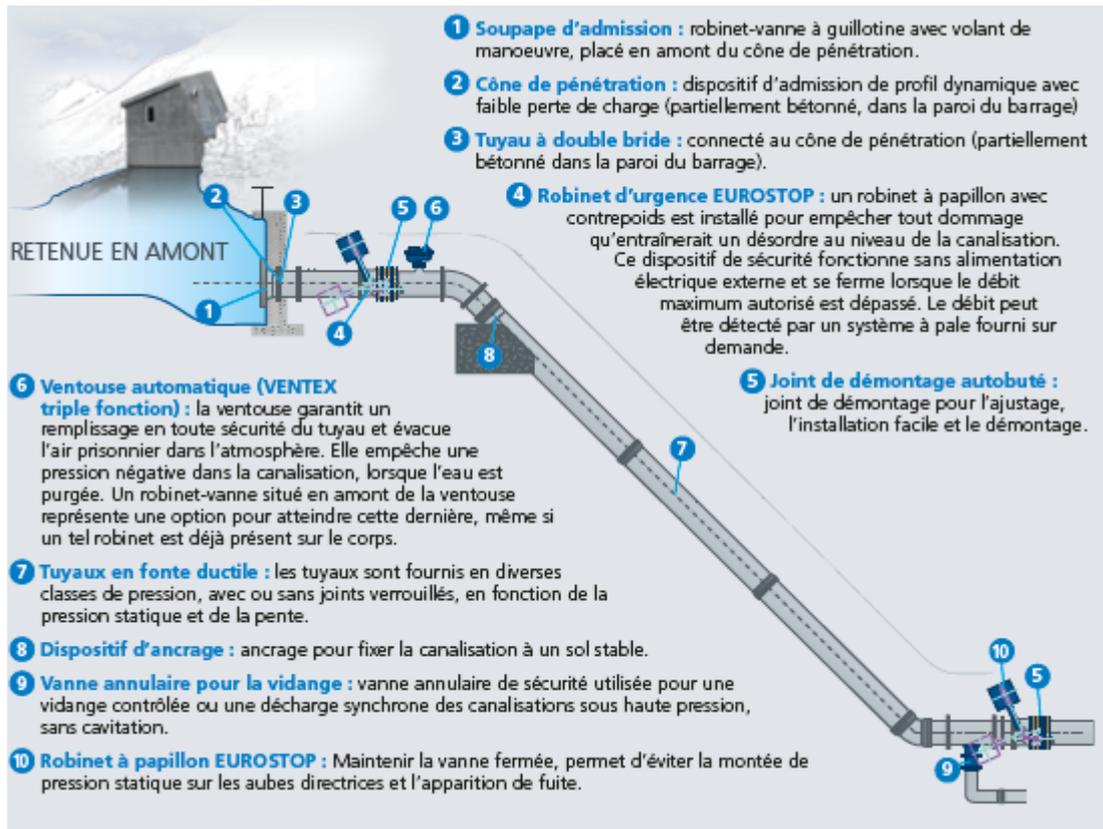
schéma d'une installation d'une conduite forcée en fonte ductile.
